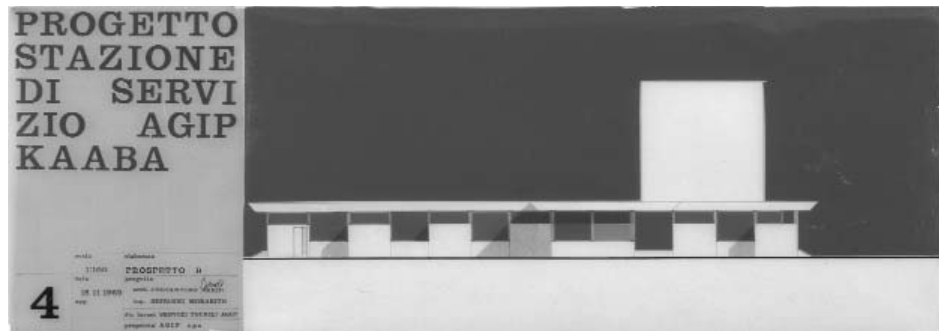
Prospetto B (Università IUAV- Archivio Progetti, Fondo Costantino Dardi ©)
